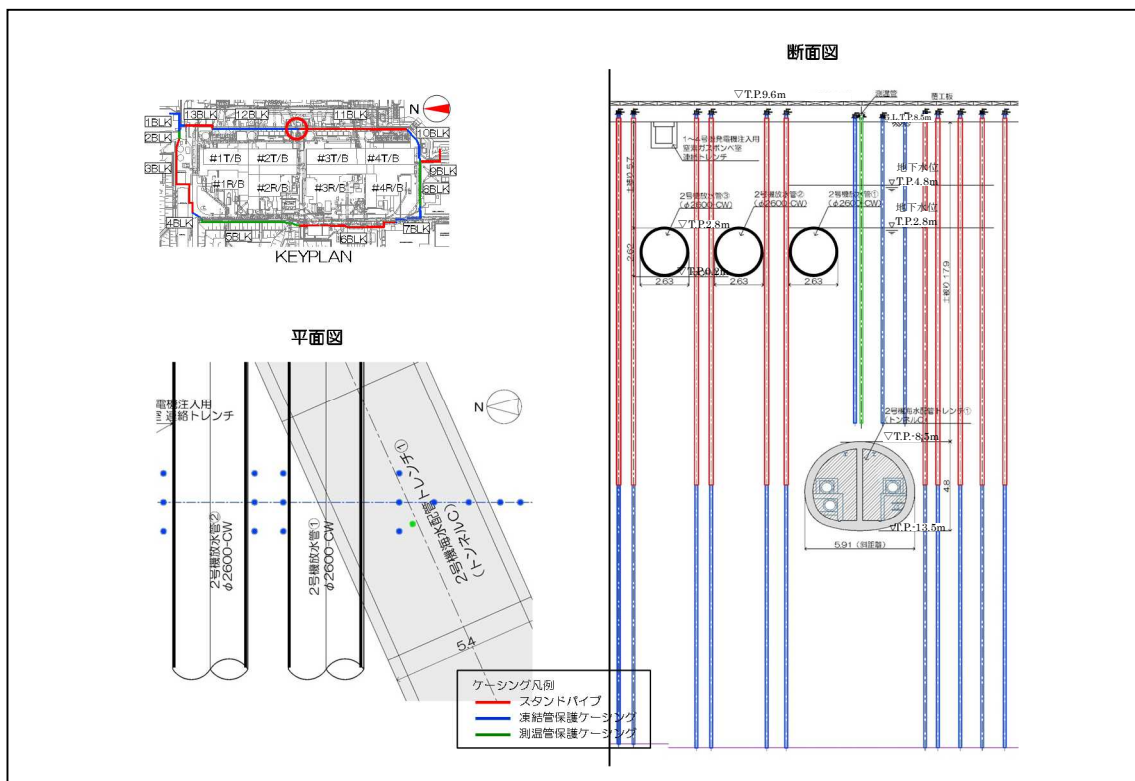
2号機海水配管トレンチトンネルC部 施工平面図・断面図
